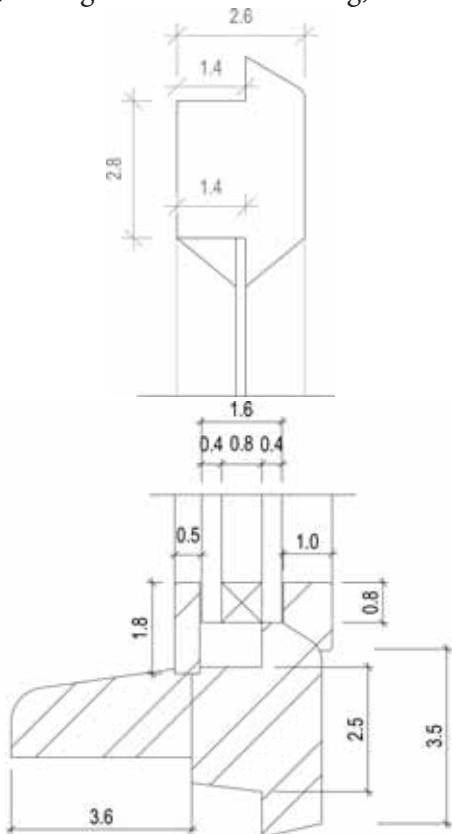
Detailplan Fenster ca. 1830 (oben mit Originalverglasung, unten mit Wärmeschutzglas)
